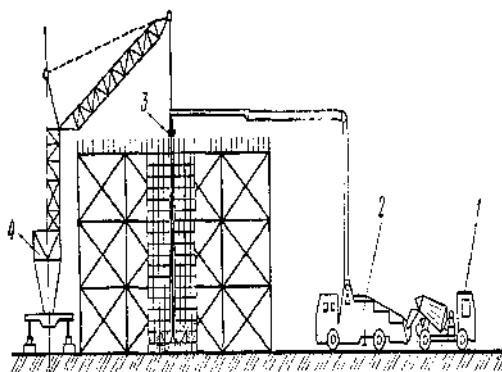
Бетонирование вертикальных конструкций напорным методом: 1 - автобетононасос; 2 - автобетоносмеситель; 3 - напорный бетонопровод; 4 - башенный кран.
